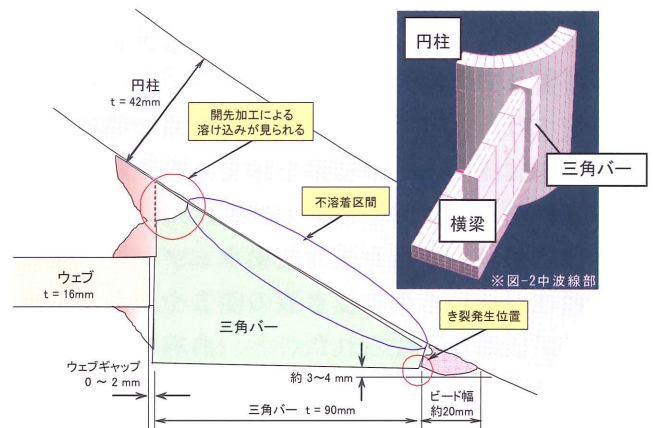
三角バー周辺の断面図 (梁と柱の接合部詳細)
